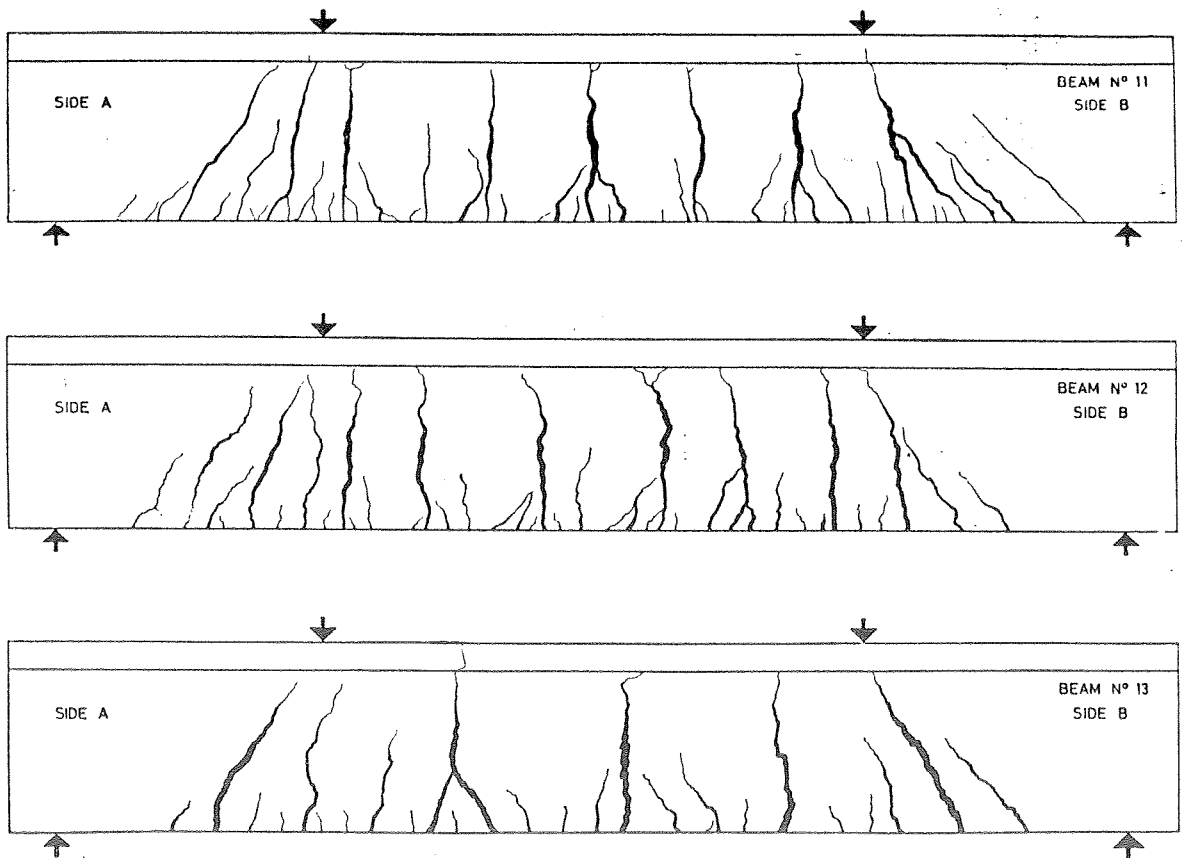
Quadros de Fissuração das Vigas 11, 12 e 13 às Escalas 1:1, 1:2,5 e 1:4 respectivamente (FERRY BORGES e ARGÁ E LIMA, 1961)
